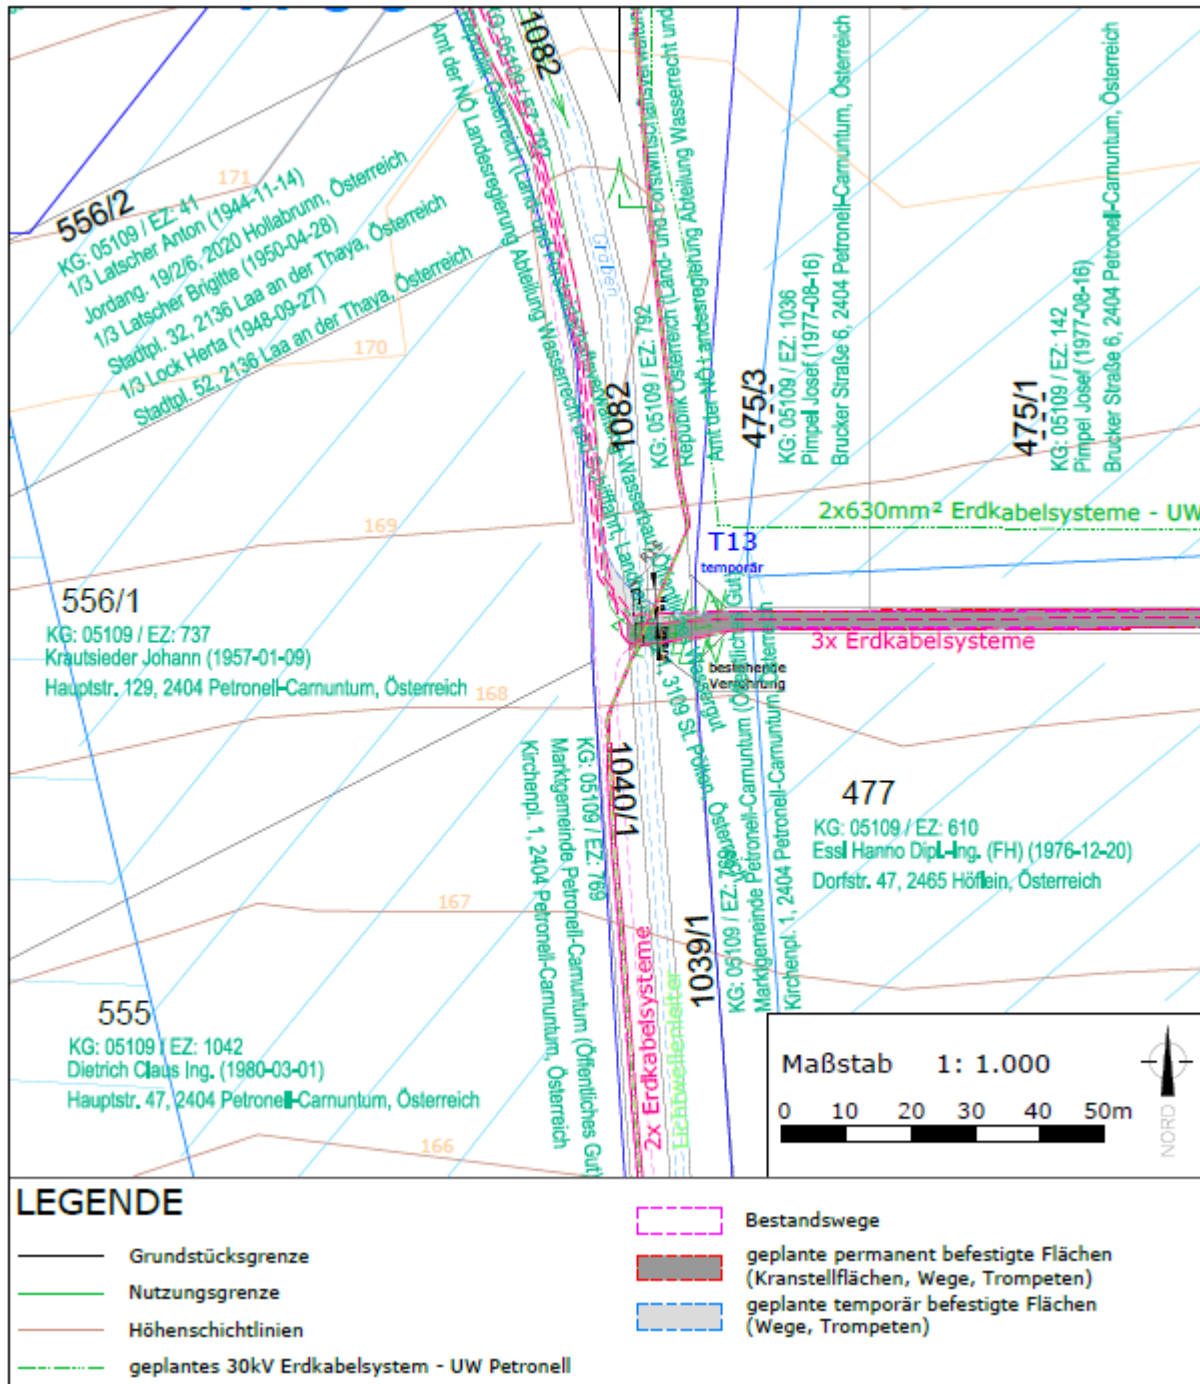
Ausschnitt aus dem Dokument B.2.4.13 Detailplan Trompete T13 1:1000, vom 9.1.2024
